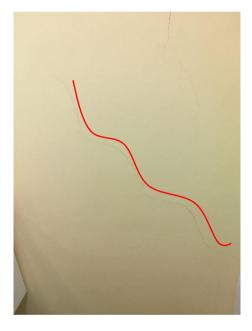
Fissuras predominante da argamassa (VISTA E)
